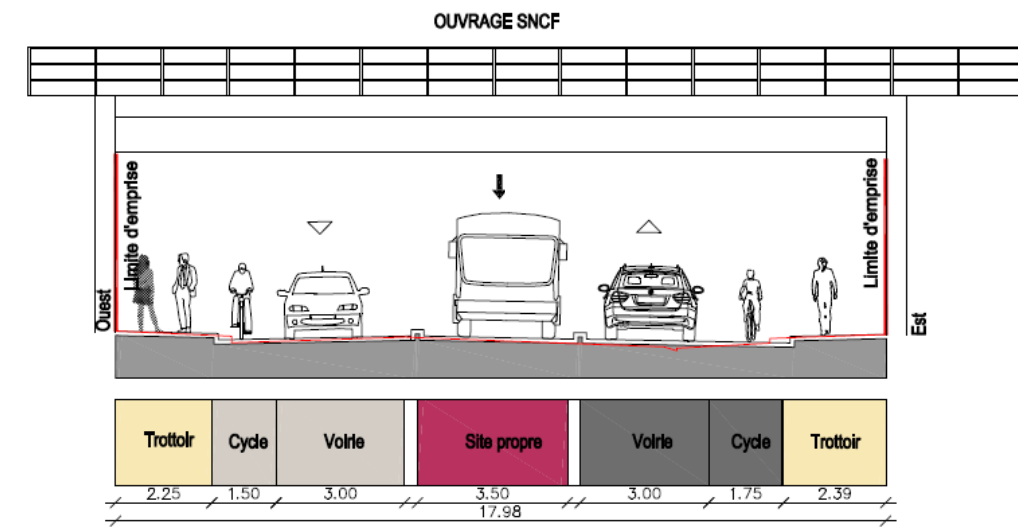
Coupe type sur la RD392 au niveau du franchissement des voies ferrées
